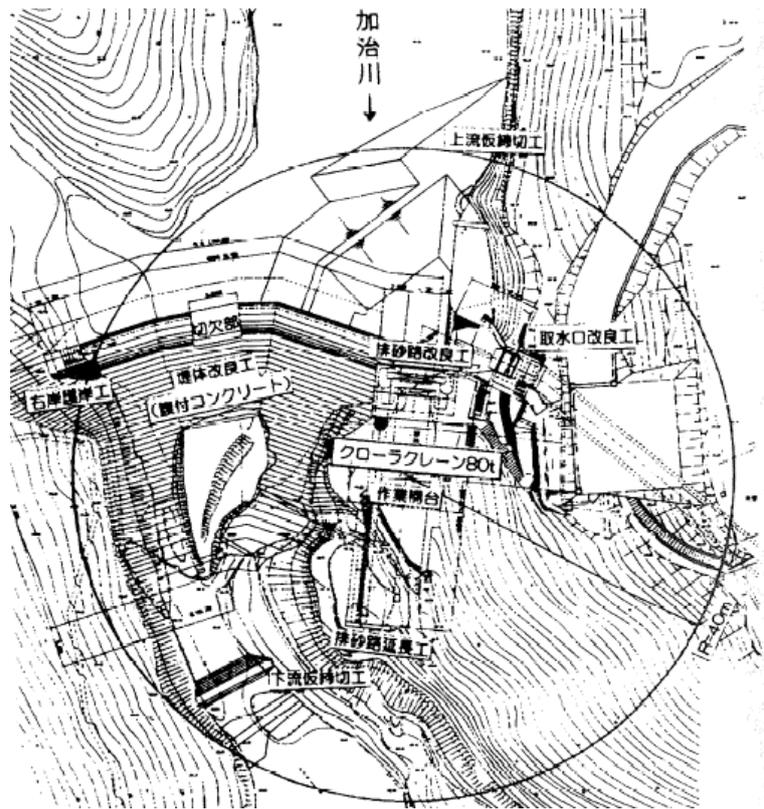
飯豊川第一ダム全体平面図²⁾
